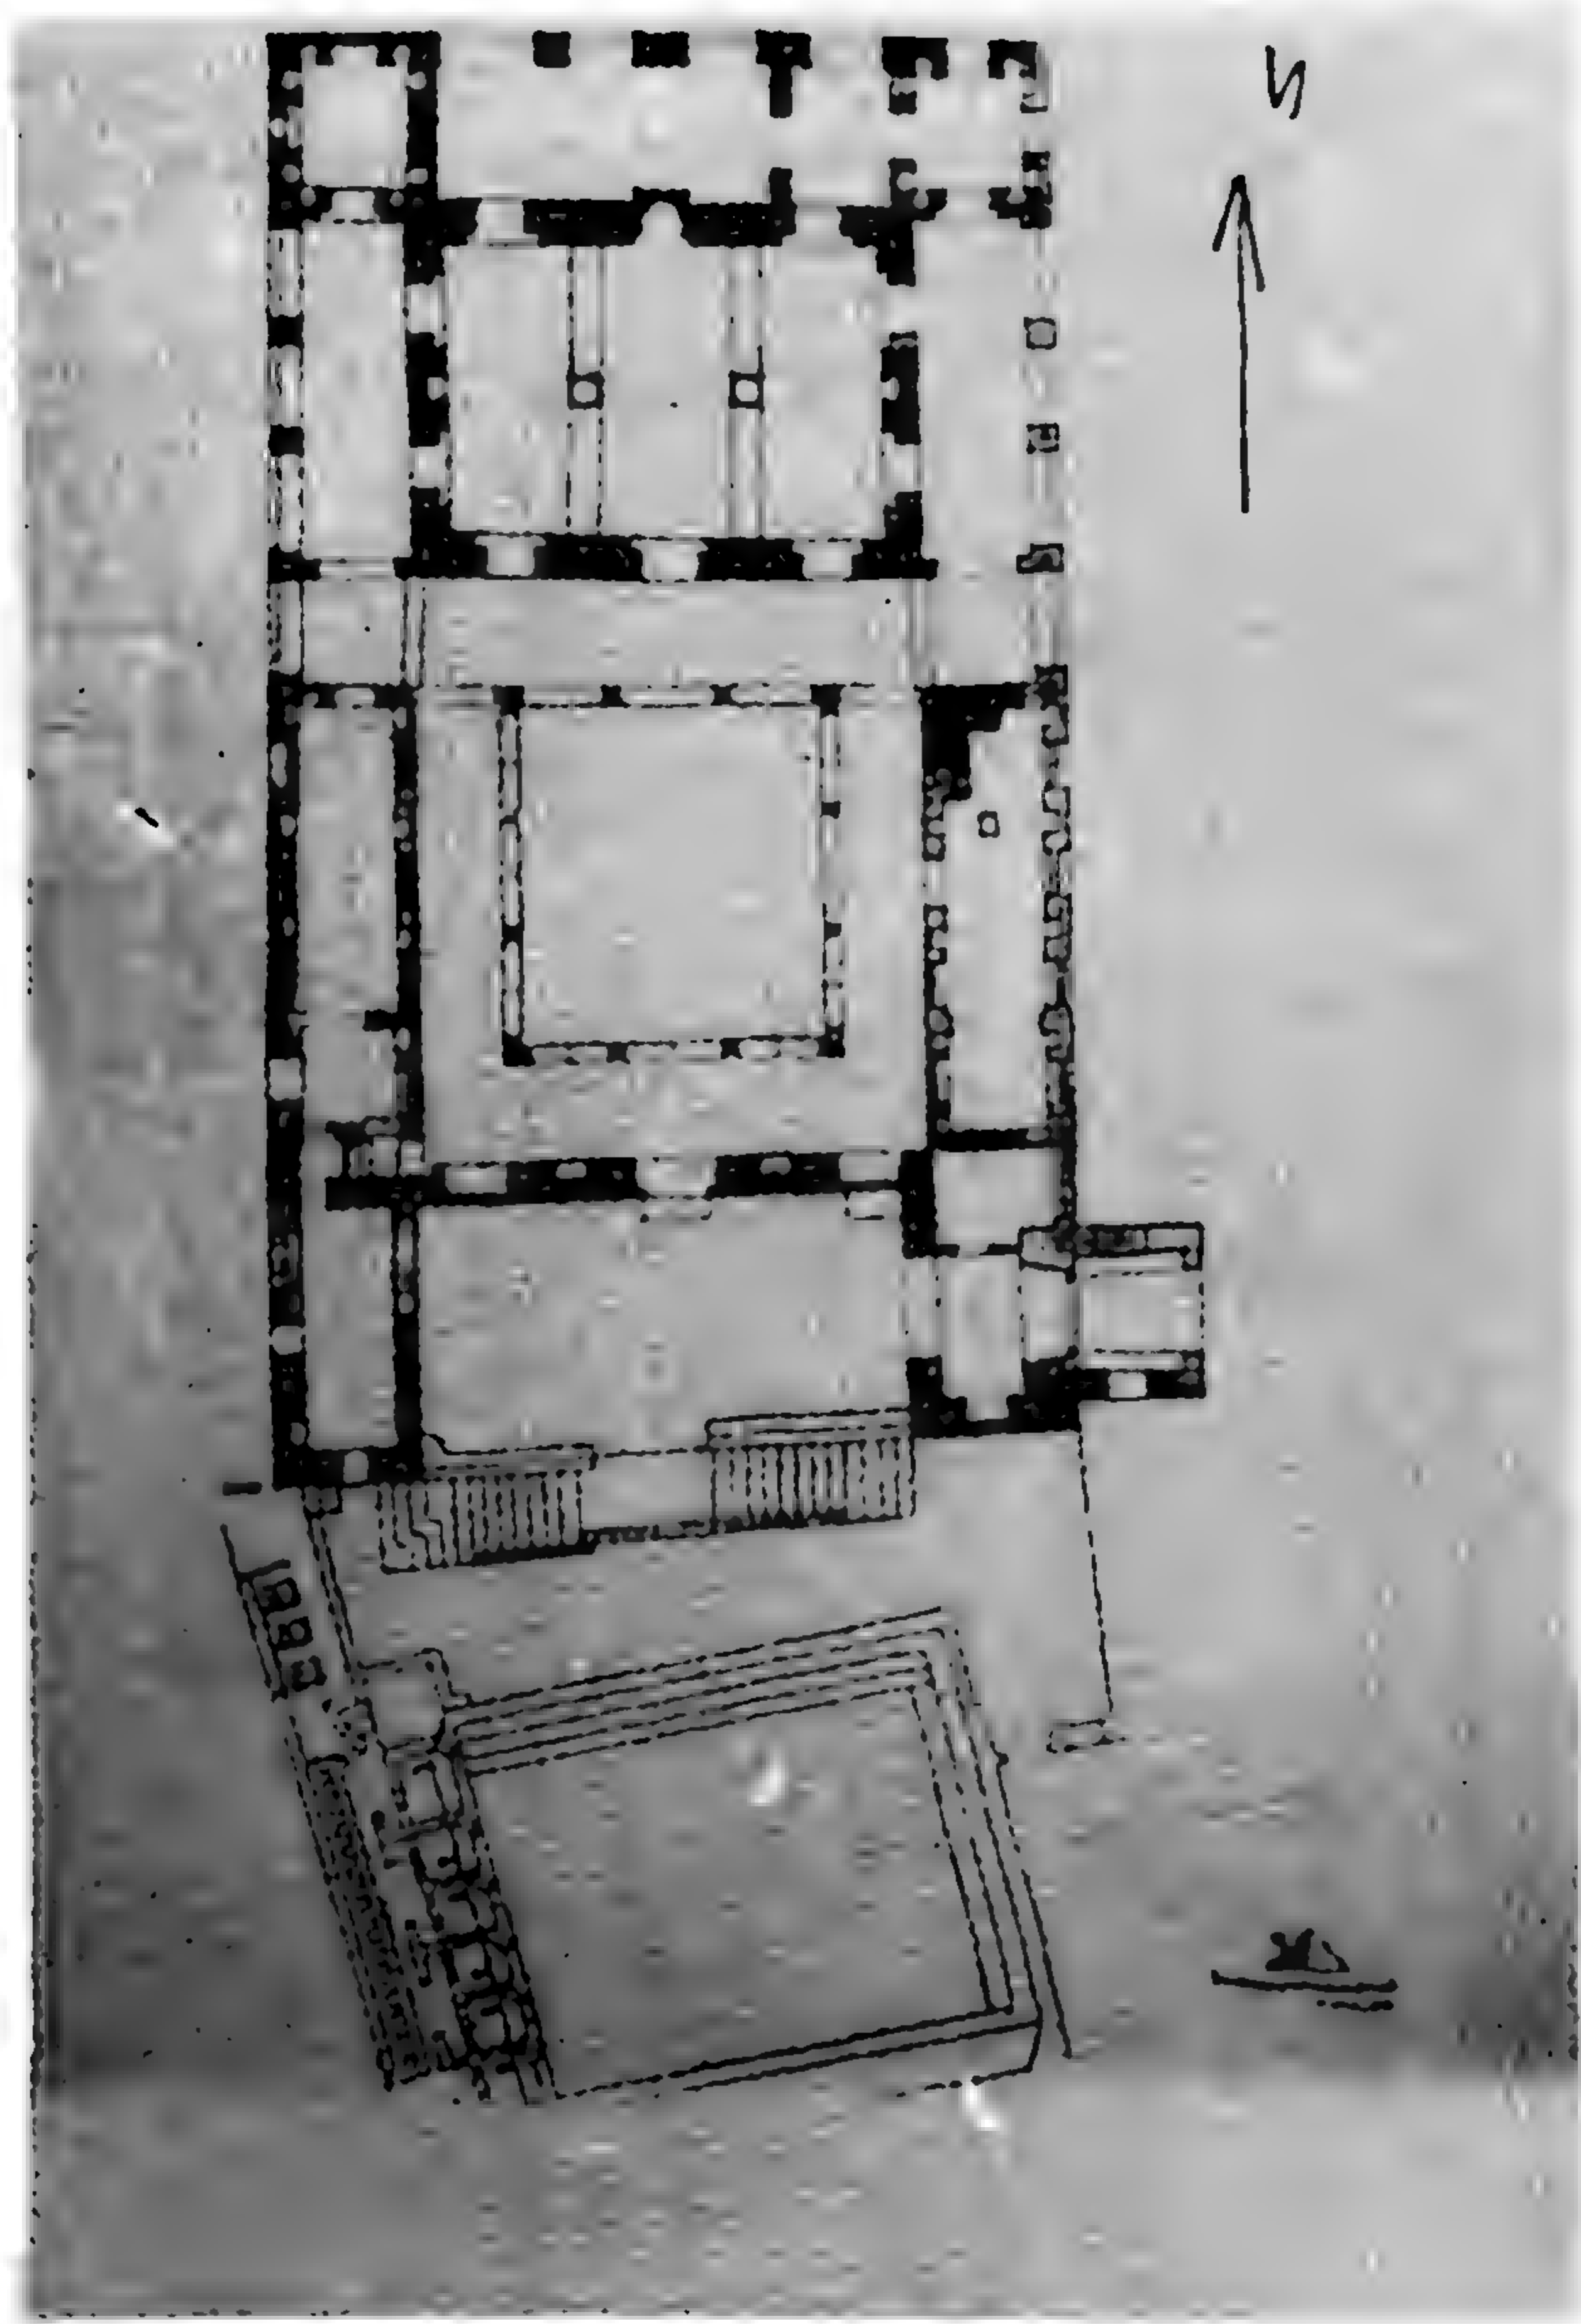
المسقط الأفقي لمسجد السيدة بنت أحمد الصلنحي Barbara Finister
